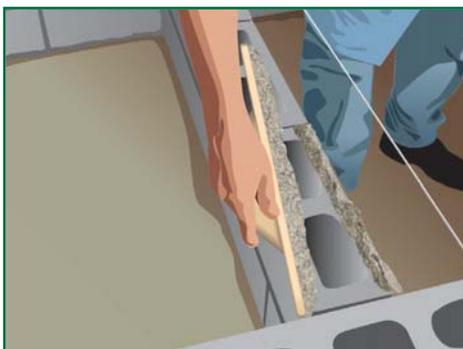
Aplicação da argamassa nas paredes longitudinais
